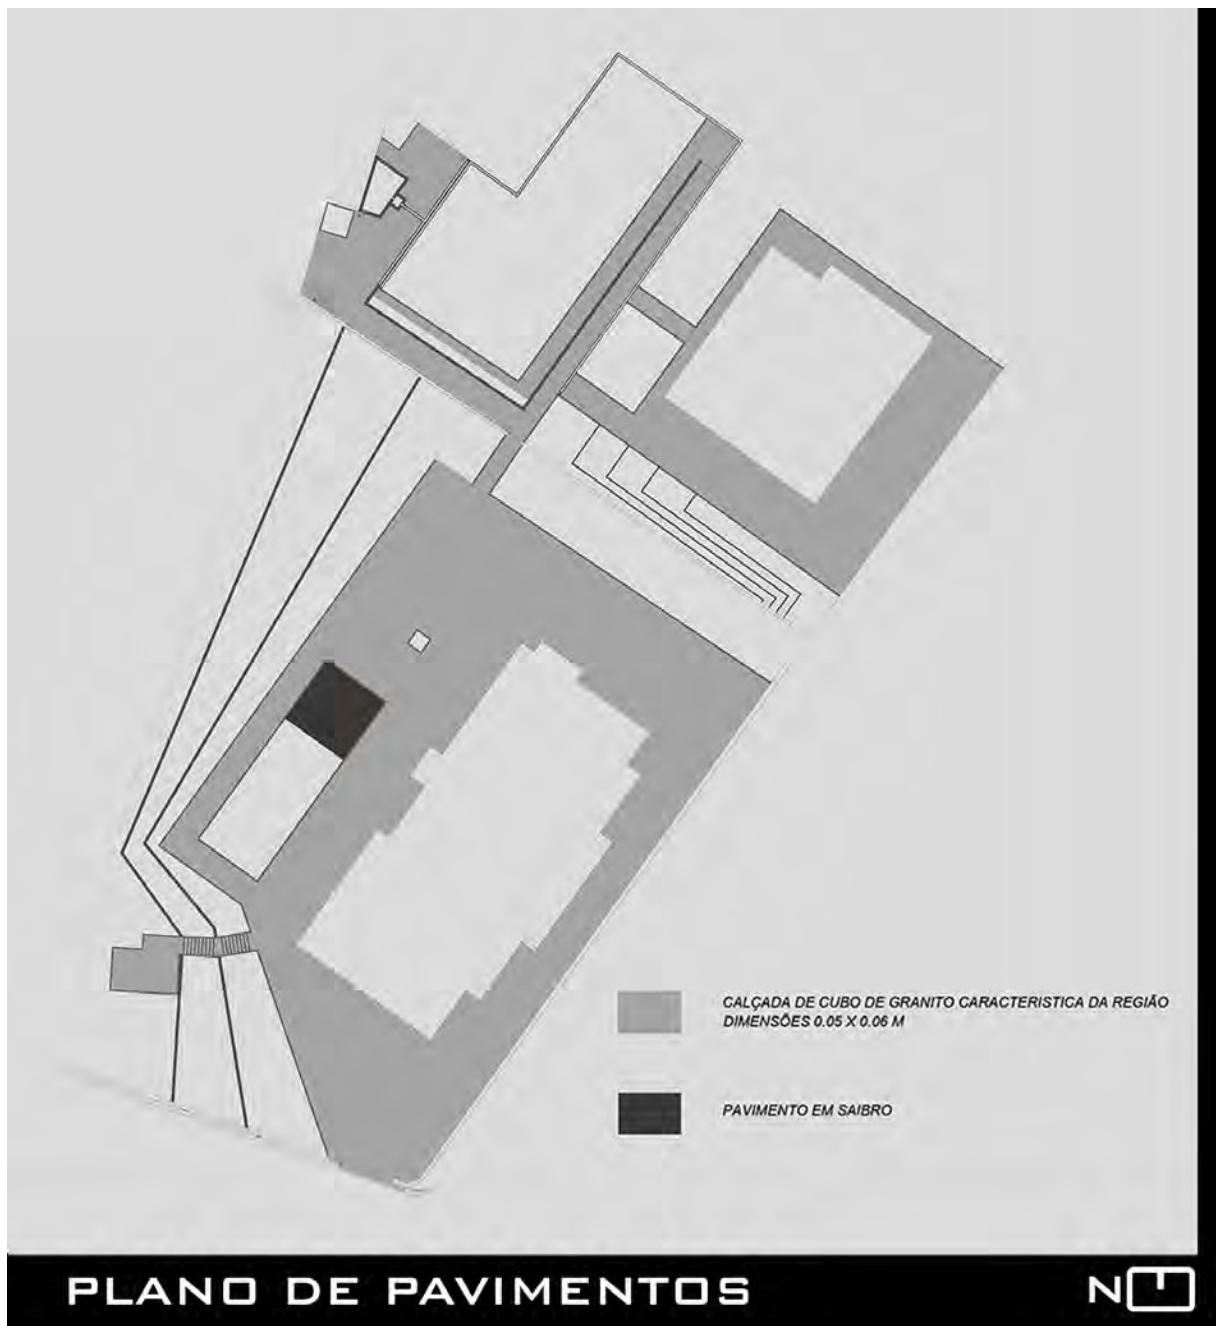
Plano de pavimentos. S/escala. Fonte Autor
